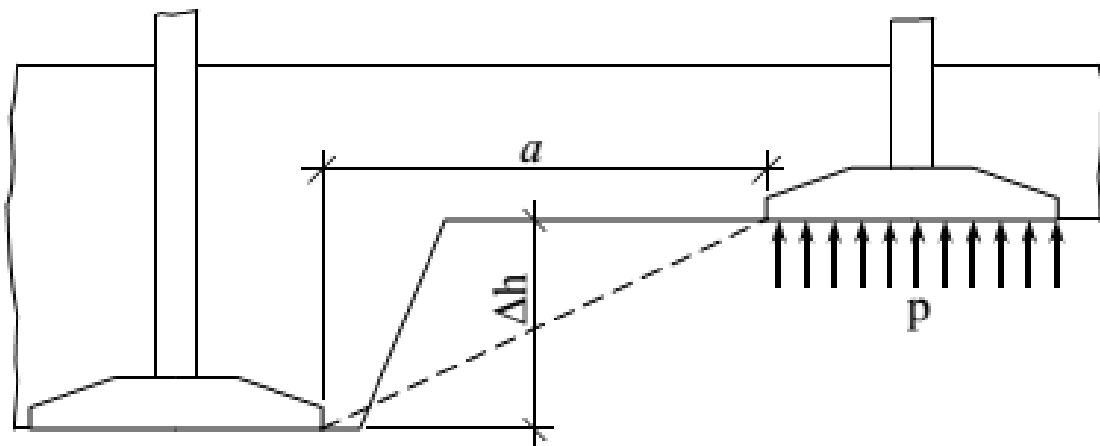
Схема примикання фундаментів, які проєктуються, до існуючих
